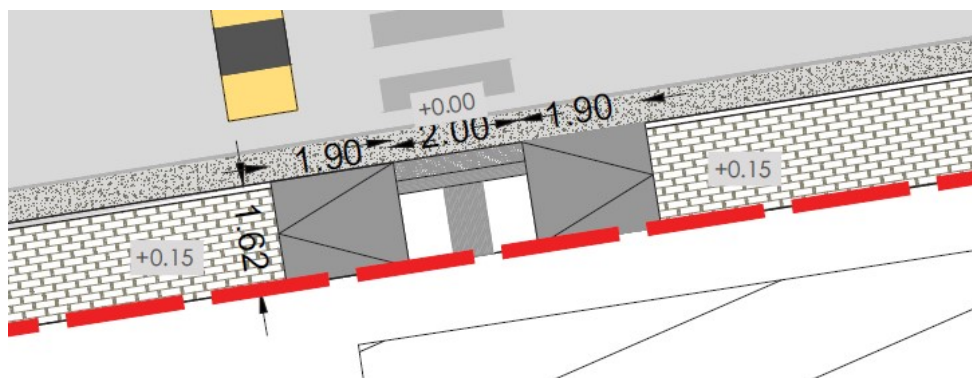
stralcio tav. di progetto PD_U_11 .MARCIAPIEDE SU STRADA DI NUOVA REALIZZAZIONE_ particolare rampa d'accesso.
